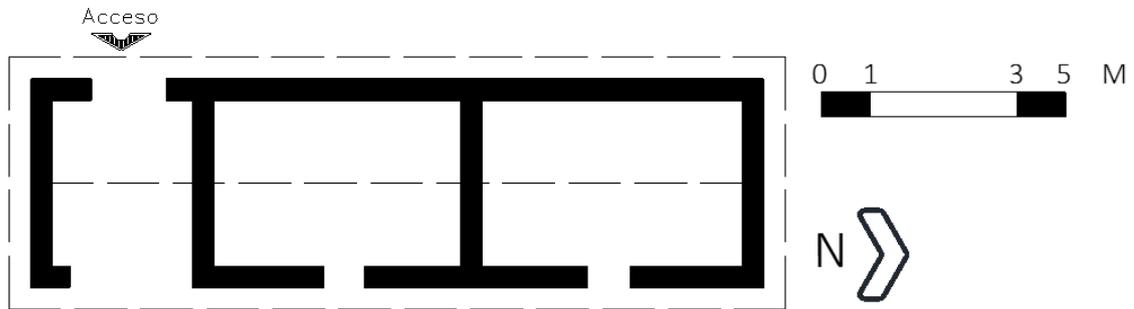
Planta arquitectónica (crédito: G. Ríos)
